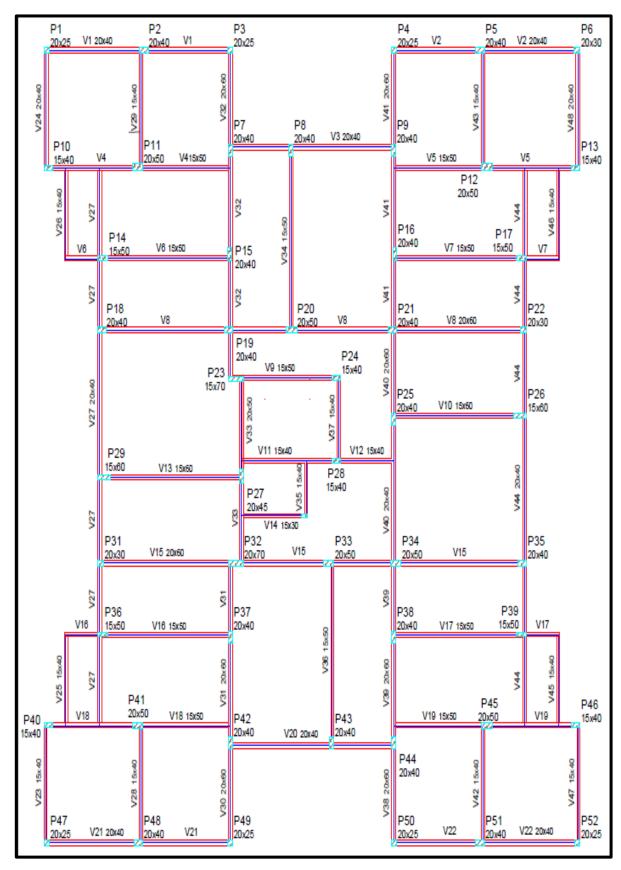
Dimensionamento da estrutura em Concreto Armado, disposição das vigas e pilares. (Fonte: Eberick (2014).
